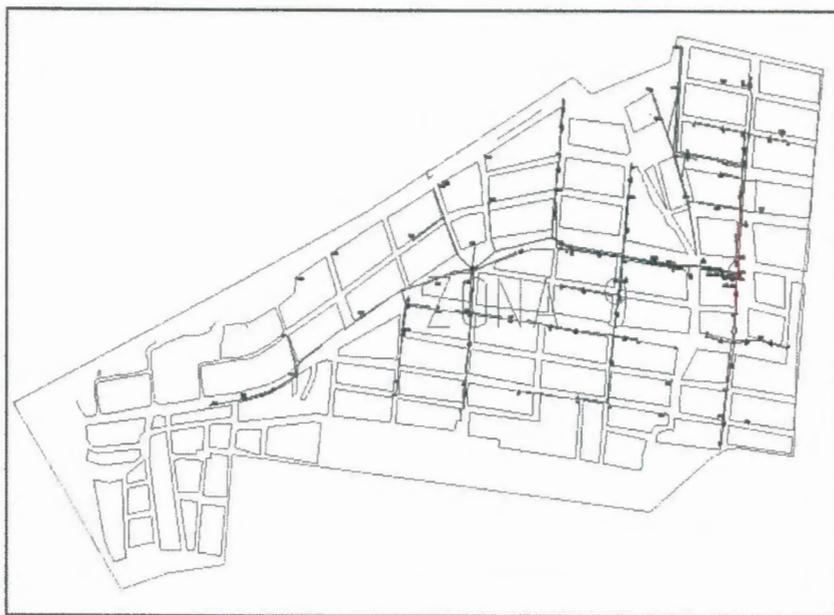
Planimetría zona 9 del sector de la vía a Daule
